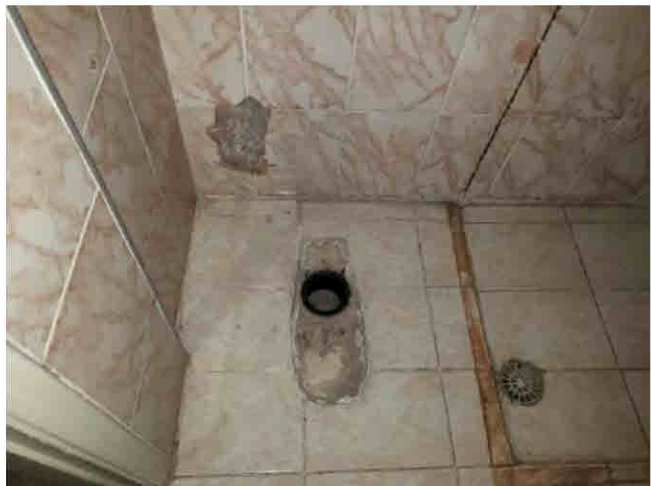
Detalhe para ausência da bacia e box no banheiro
